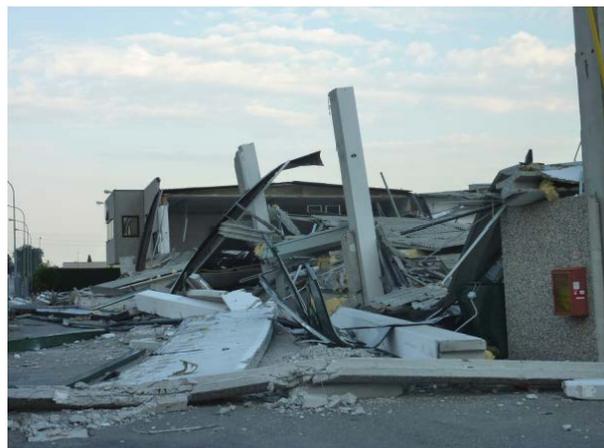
Collasso globale dell'edificio: perdita di verticalità del pilastro
